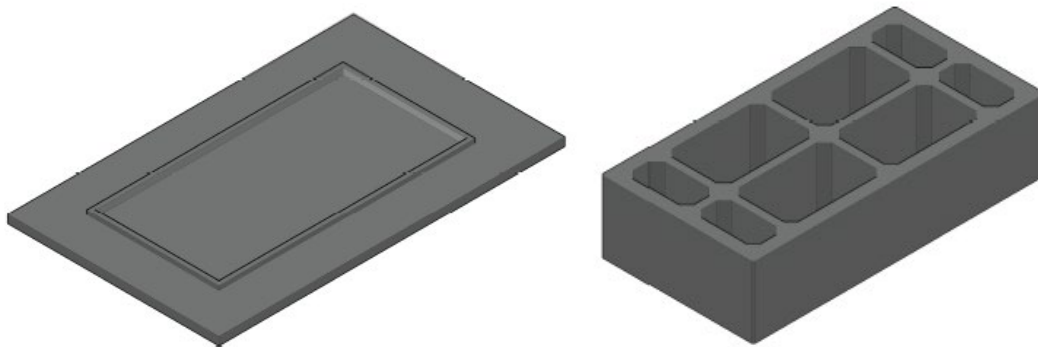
vista de losa cimentación y bloque prefabricados para conformar las pilas-cajón.
